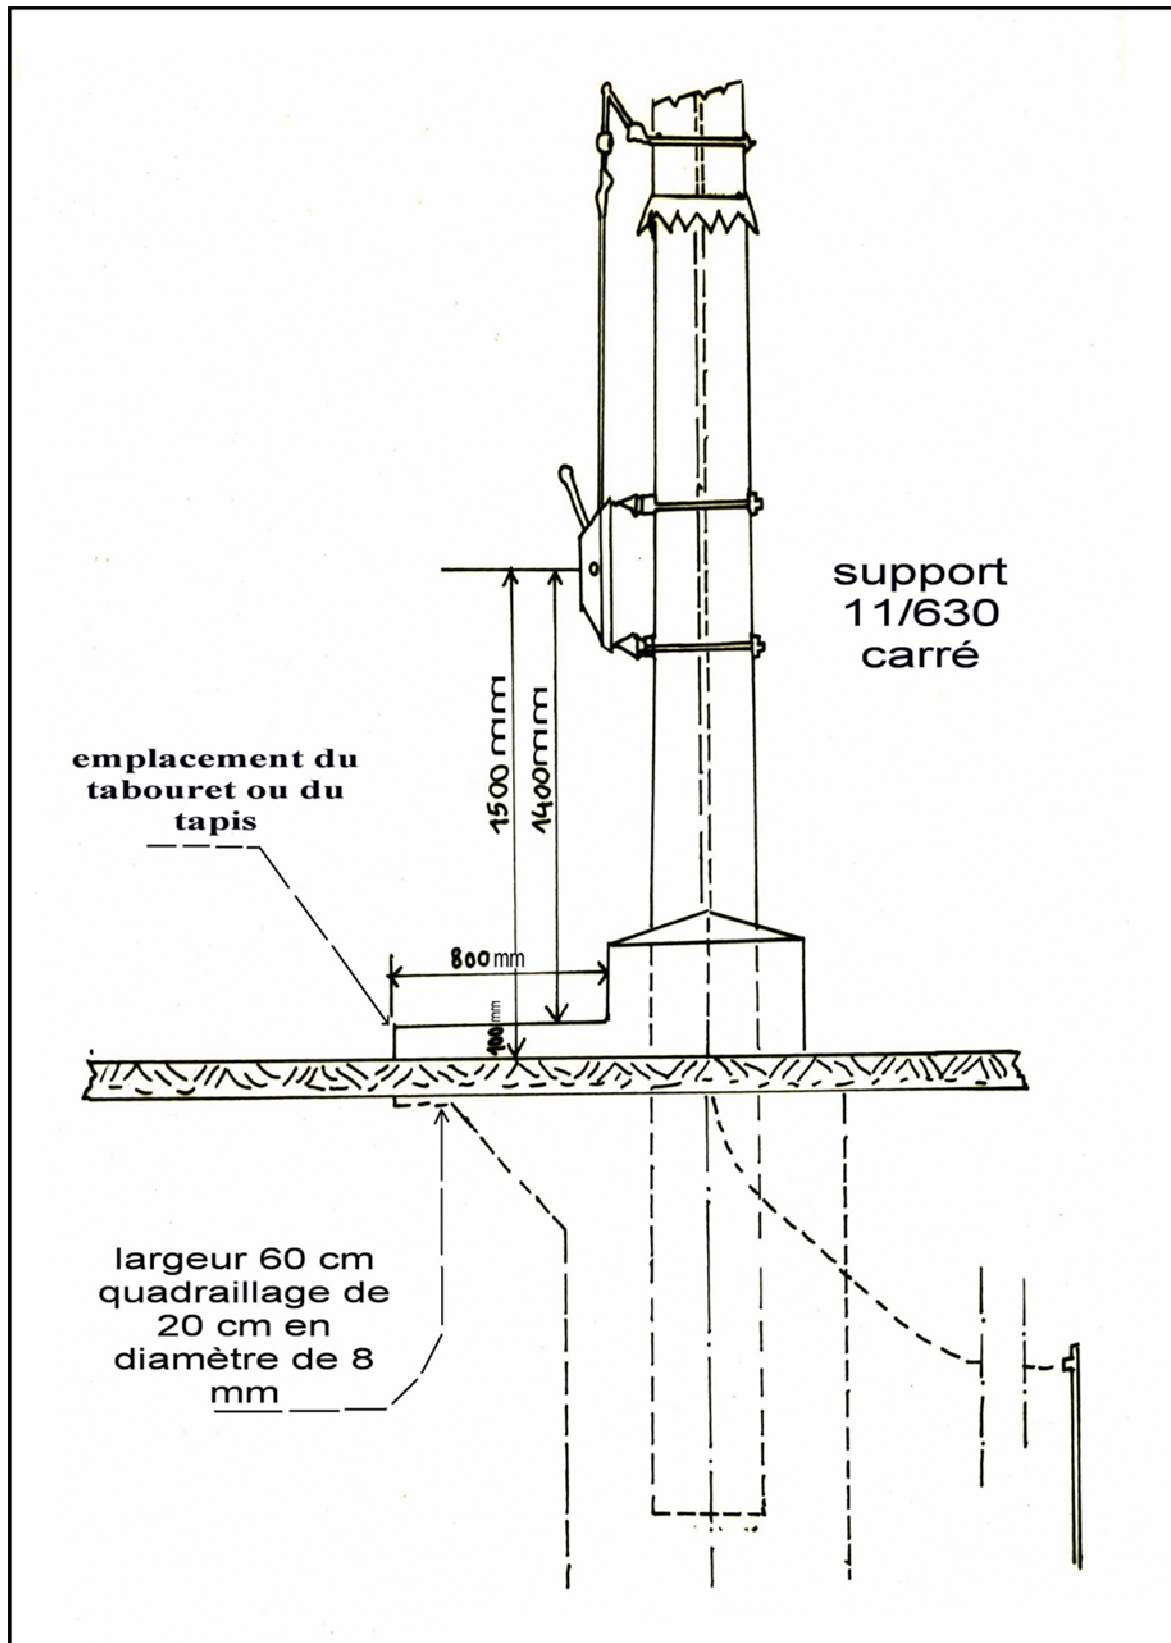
Fondation et dalle de manœuvre d'un poste ACC
